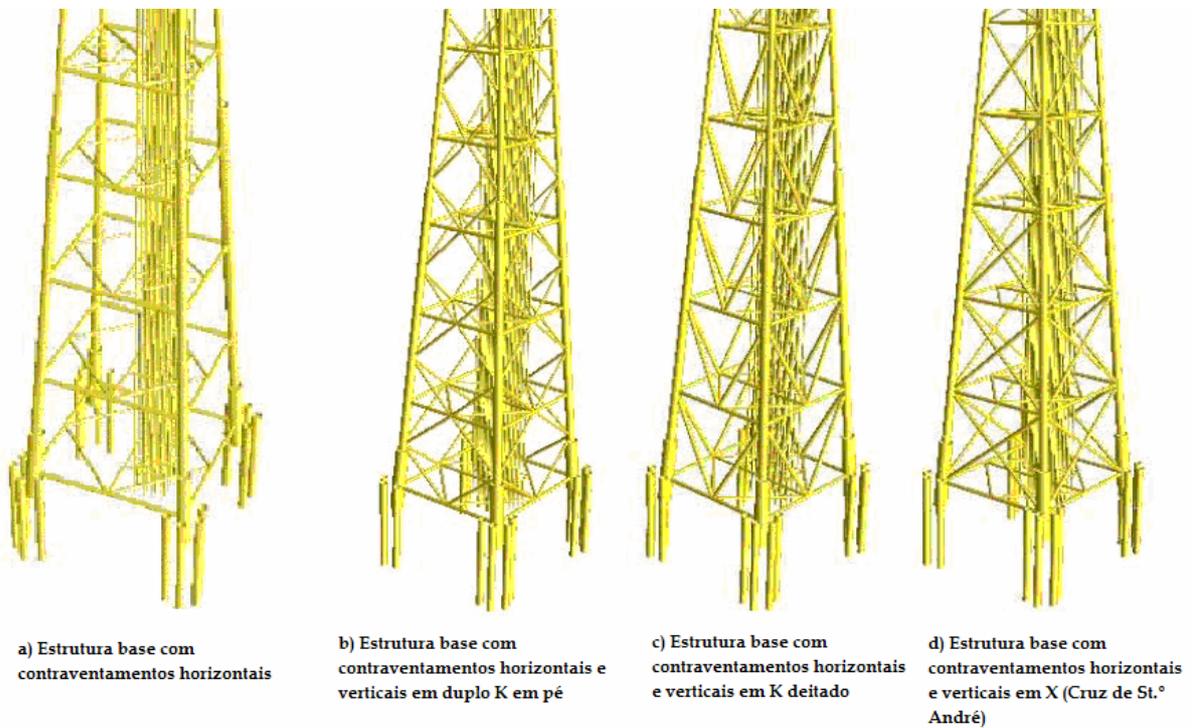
Contraventamentos em sistemas de apoio espaciais [23]
